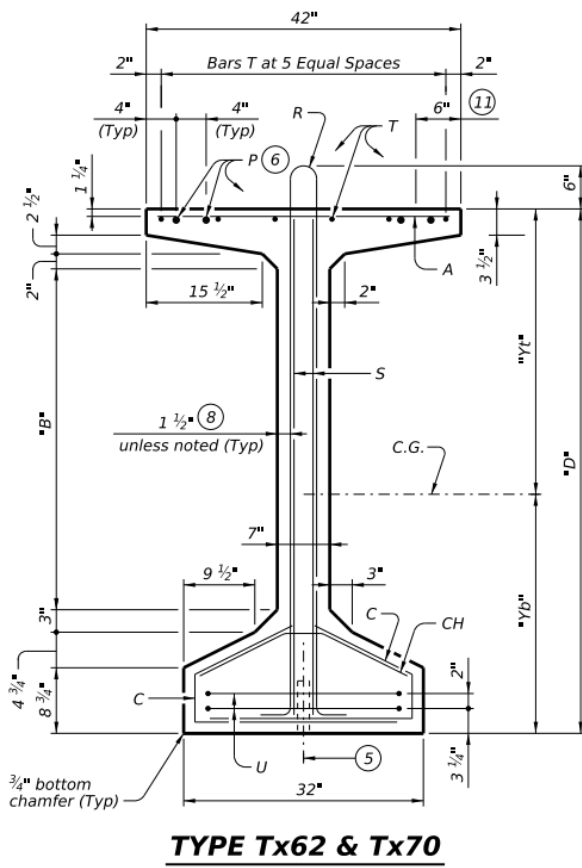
Sección de la viga Tx70, según el plano standard del TxDOT.
